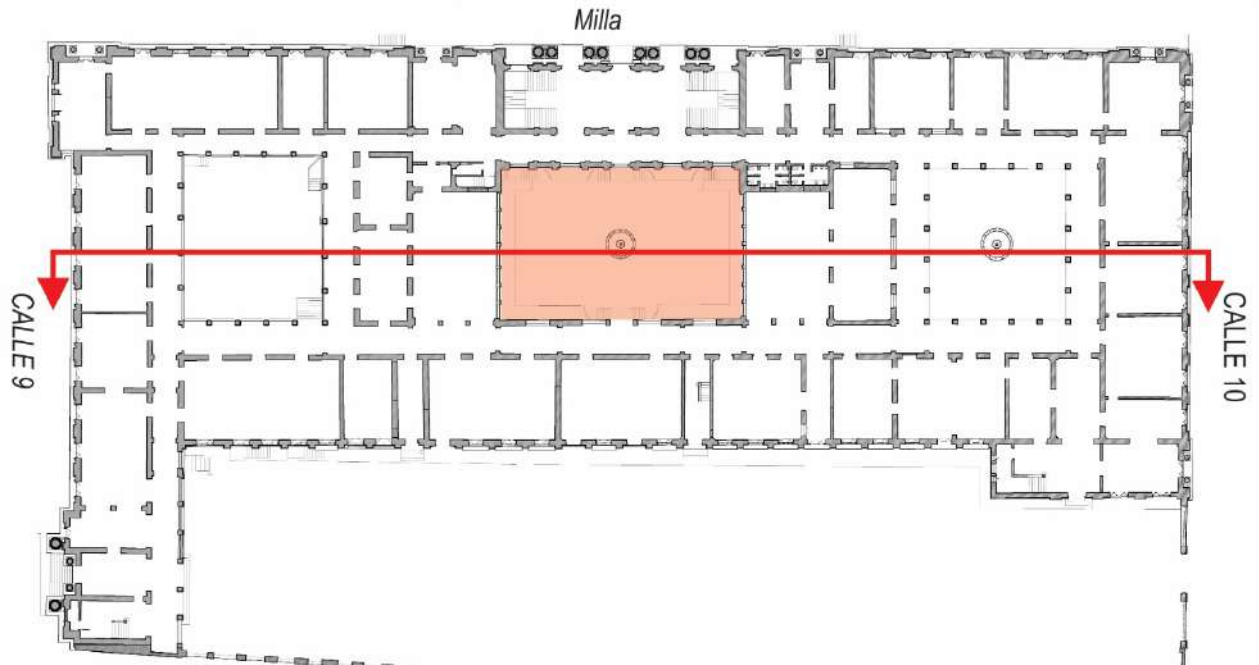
Esquema de ubicación del patio central Planta de Primer Piso
